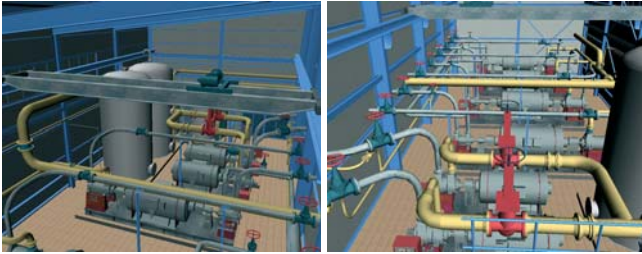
Príklad časti zosnímaného technologického komplexu pomocou 3D skenera
